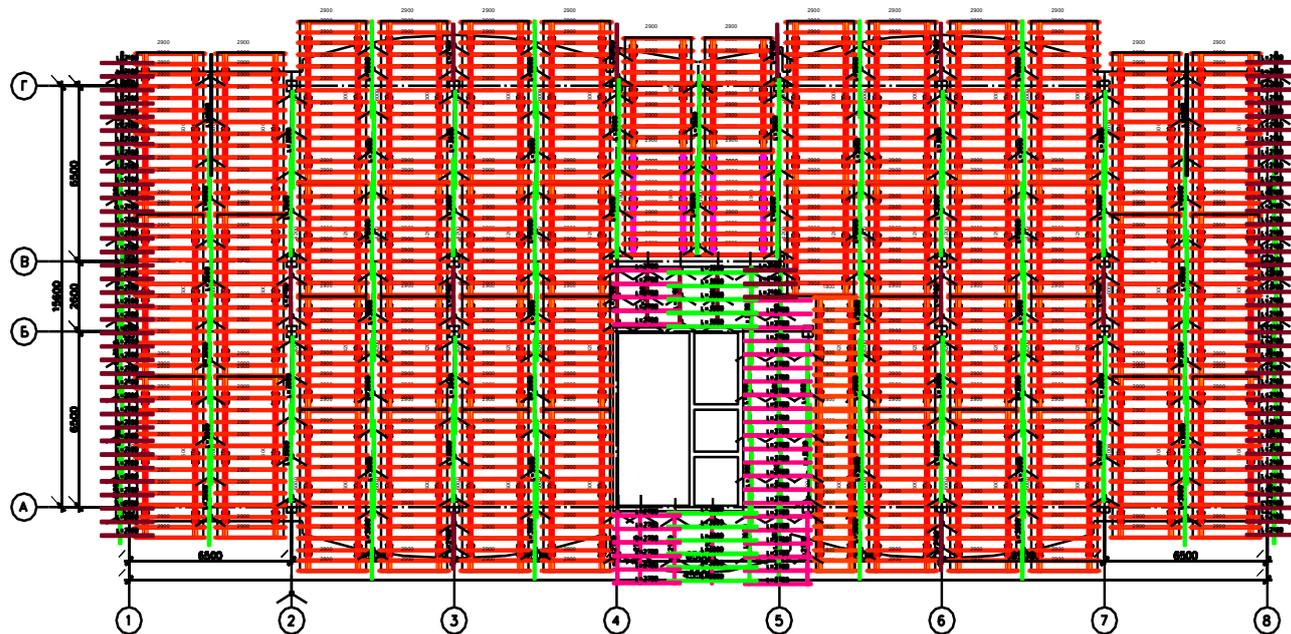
Расположение столовой опалубки перекрытия
